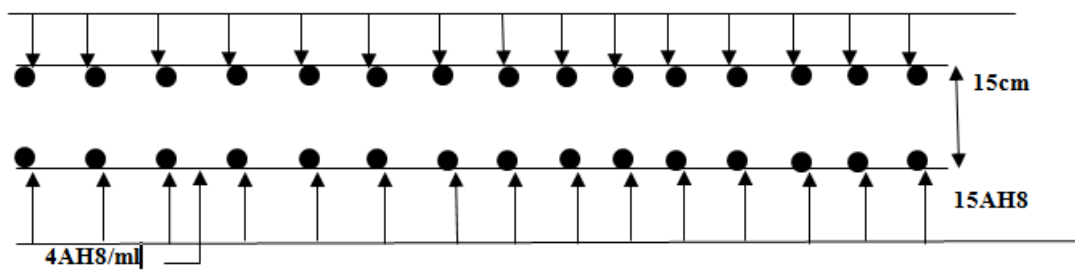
Schéma de ferrailage de la dalle sur quatre appuis.
